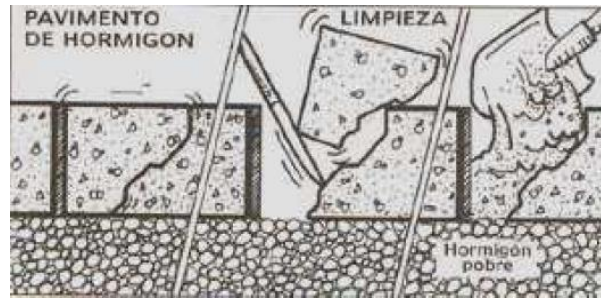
Rellenado de huecos en losas de hormigón con hormigón pobre
